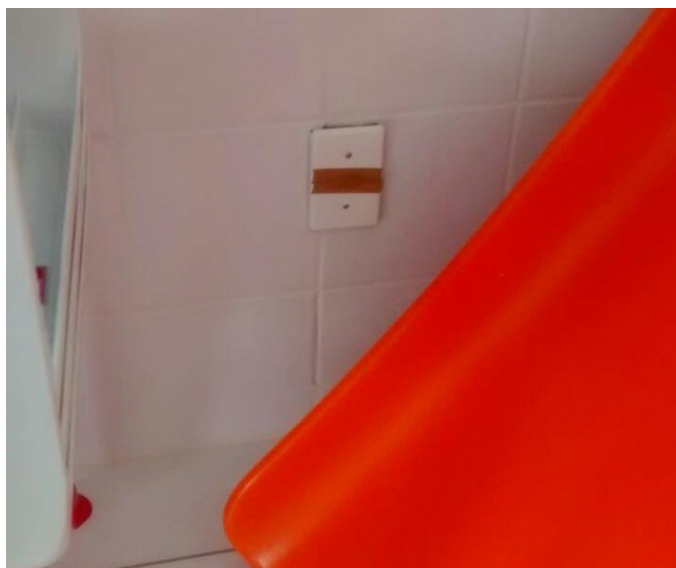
Dispositivo de proteção das tomadas improvisado. (Fonte: Dos autores 2016)
